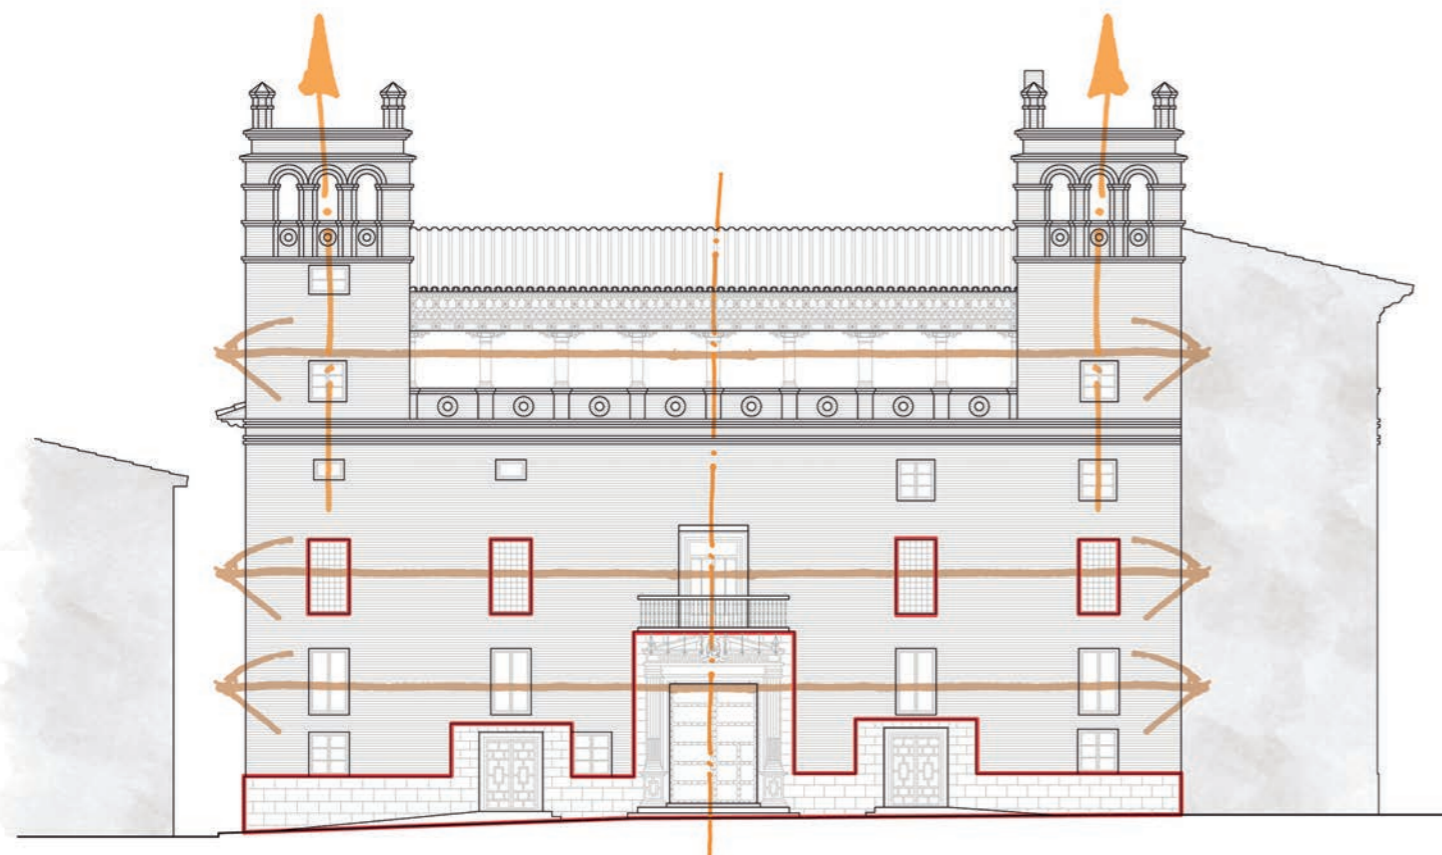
Alzado principal. Destaca la pieza de zócalo, la linealidad de las ventanas apoyada con el mirador frente a la verticalidad de las torres, se genera un eje de simetría en la composición.
